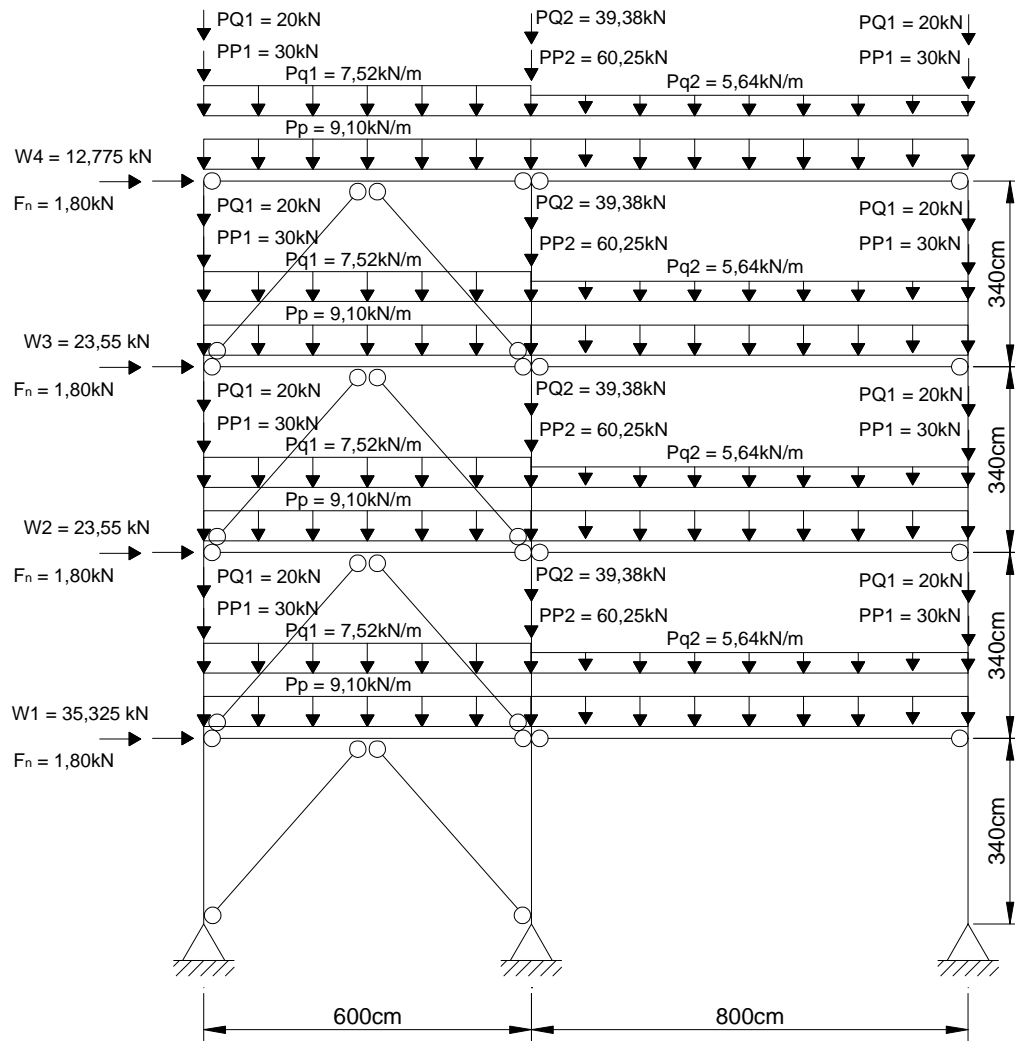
Pórtico contraventado de quatro pavimentos, com as ações aplicadas com seus valores característicos.
